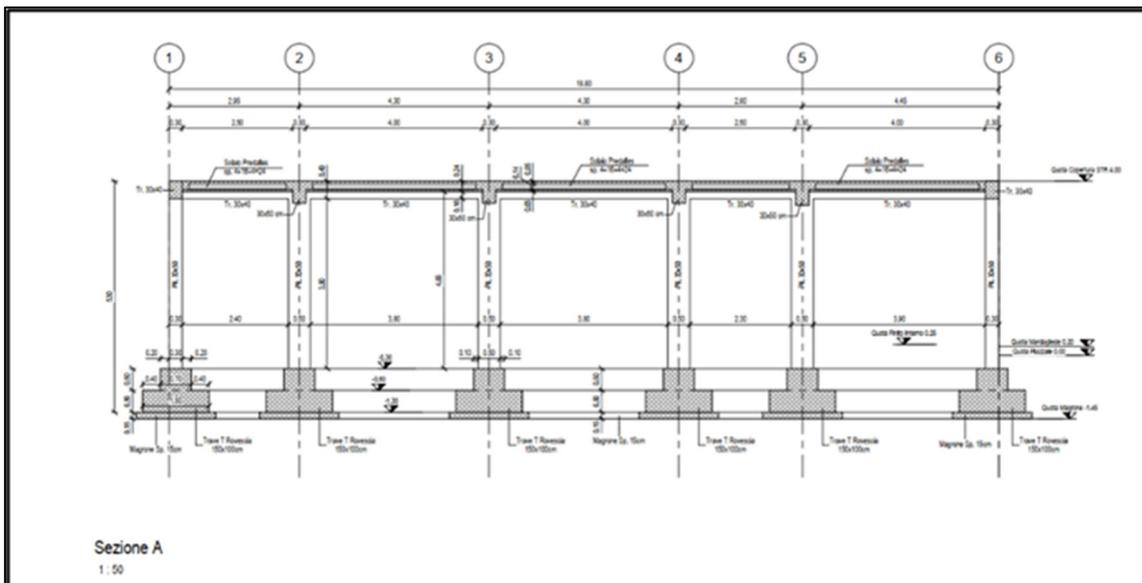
Sezione longitudinale Fabbricato tecnologico
